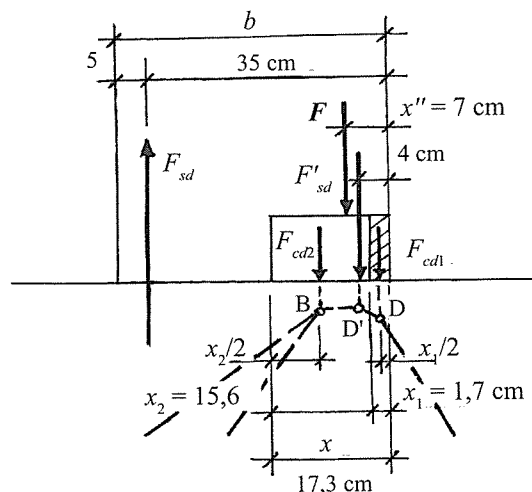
Détail du nœud sous poteau dans le plan de flexion.
